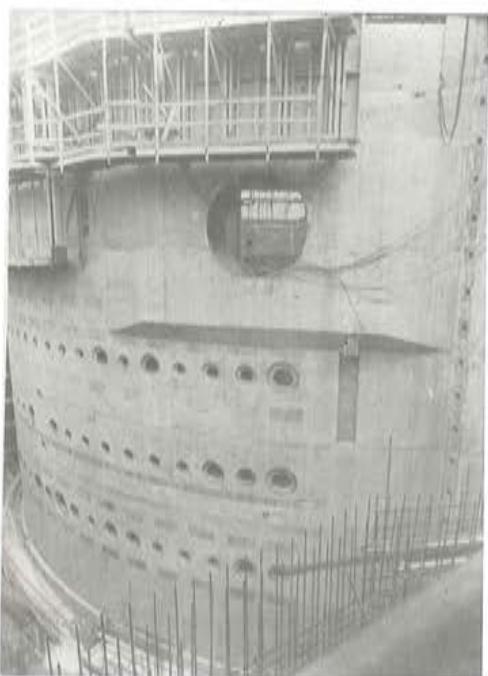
Fase de construcción Edificios Principales Grupo I.
